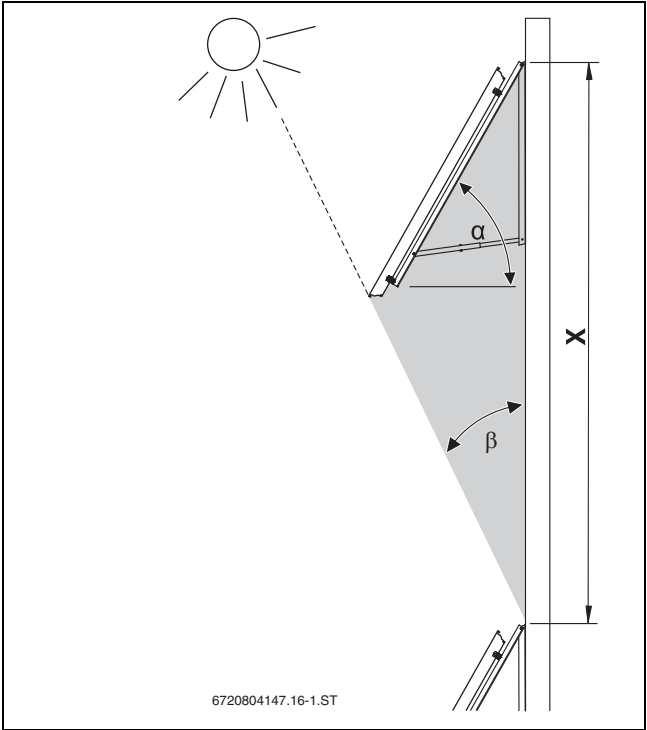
Vermeidung von Verschattung, Fassadenmontage
